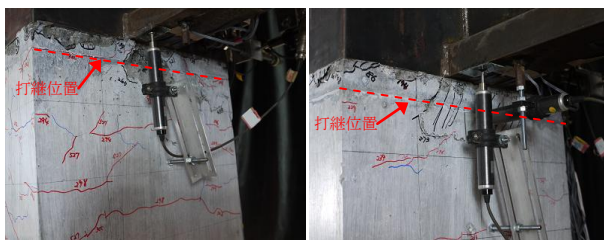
No.4(R=1/50rad.) 写真-2 No.6(R=1/100rad.)
